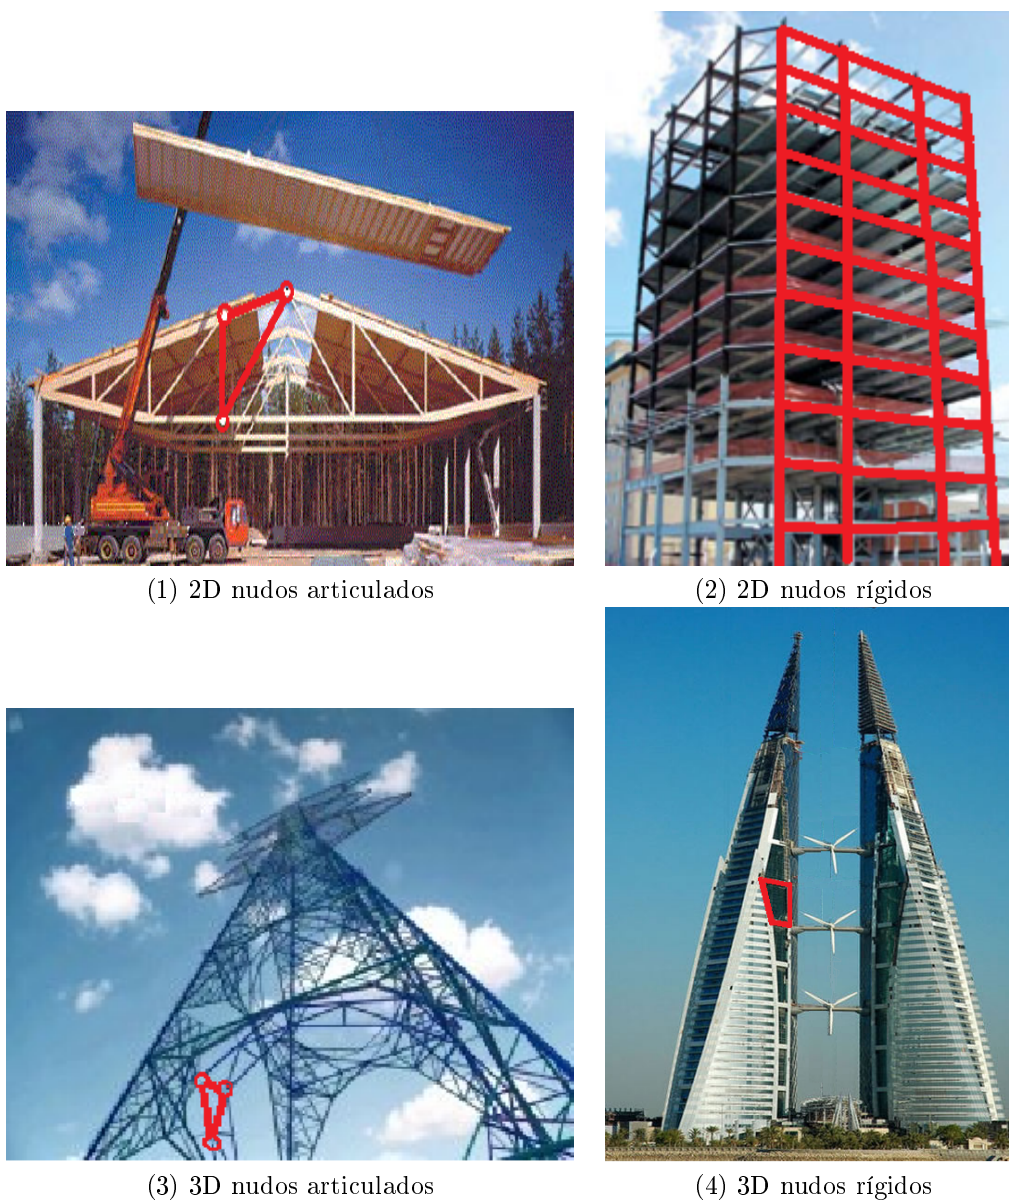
Clasificación por la conexión de las barras en las estructuras planas (2D) y espaciales (3D). En las figuras se resaltan líneas en color rojo indicando en la estructura cuales son los elementos barras y sus interconexiones llamados nodos
